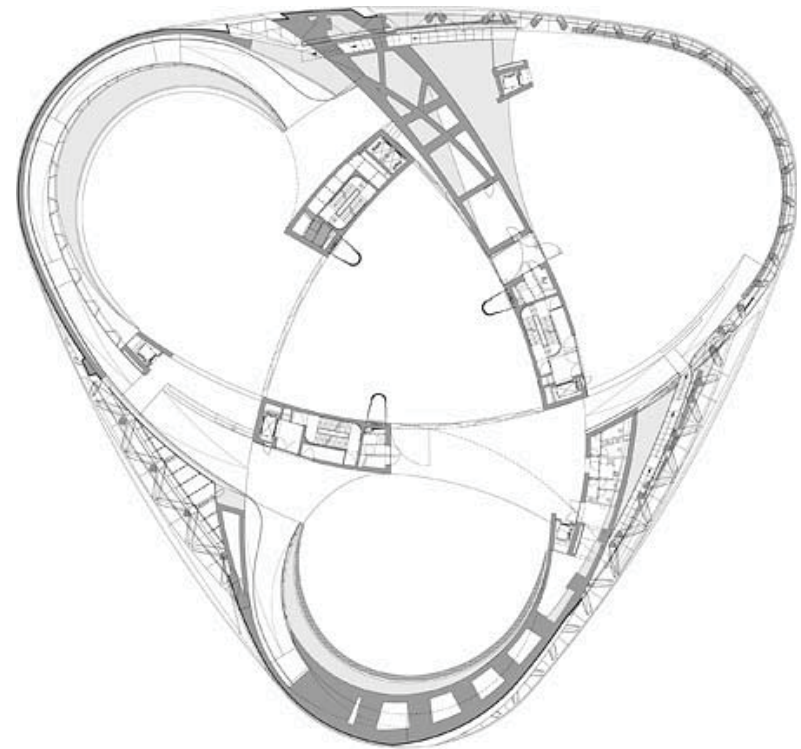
Grundriss Ebene 5²⁶
